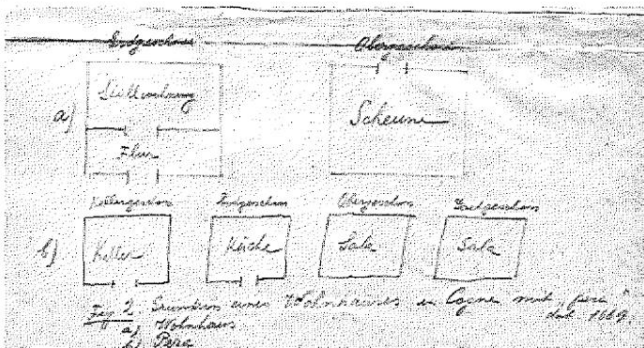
Grundriss eines Wohnhauses in Cognac mit „pera“, dat. 1669
